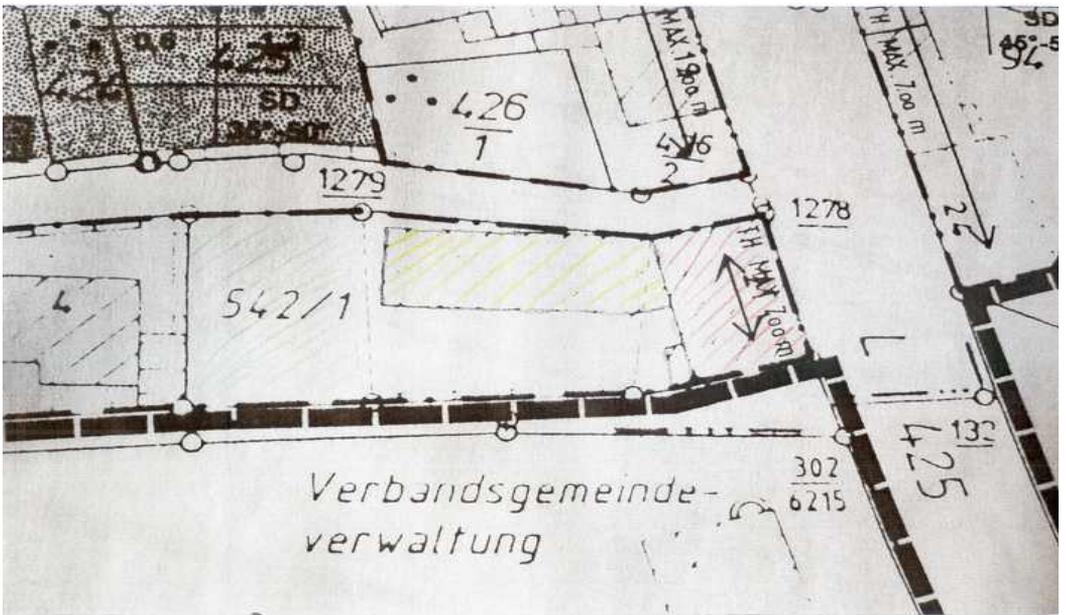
Lageplan 1996 Kindergarten mit Anbau von 1957 und Garten Nr. 542/1
